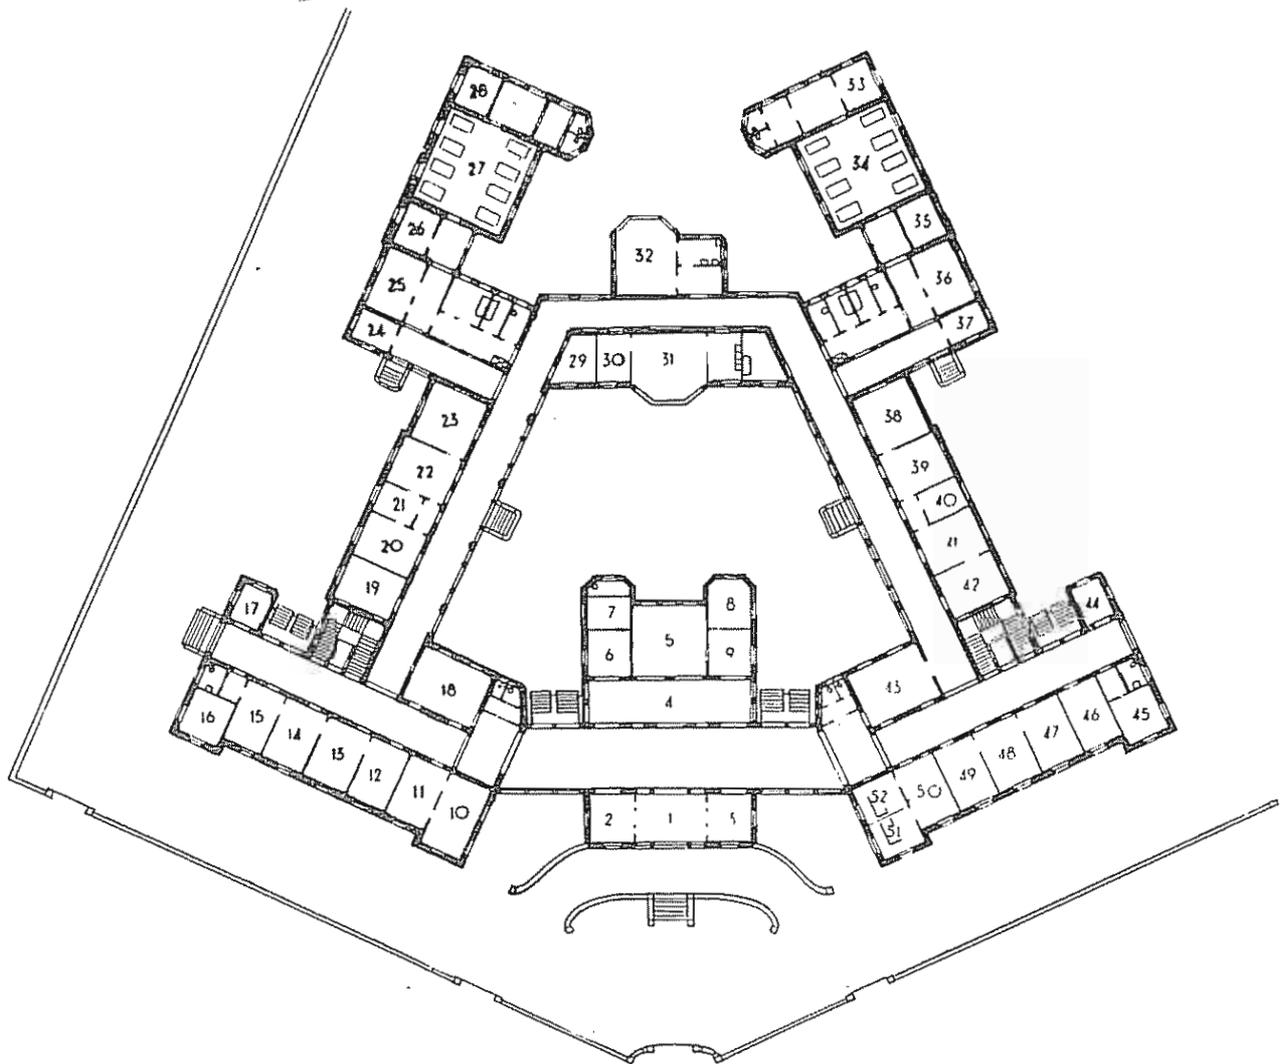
PIANTE DEL PADIGLIONE DI ACCETTAZIONE E GUARDIA - PIANO RIALZATO
